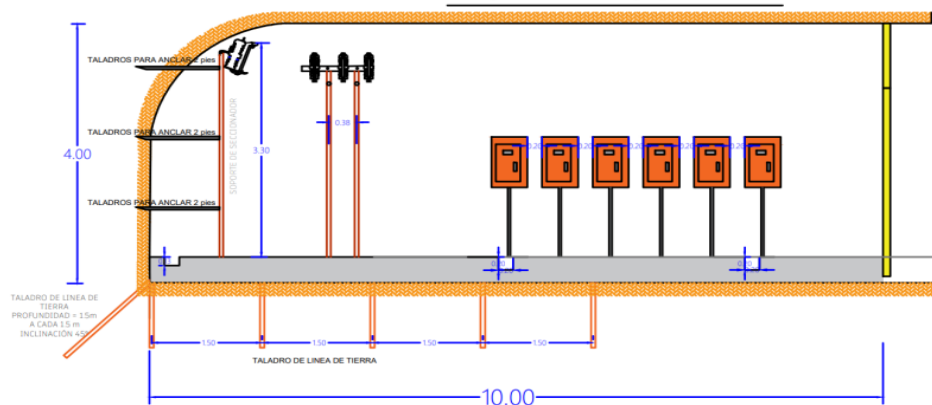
Dimensiones de subestación (vista de planta/sección)
